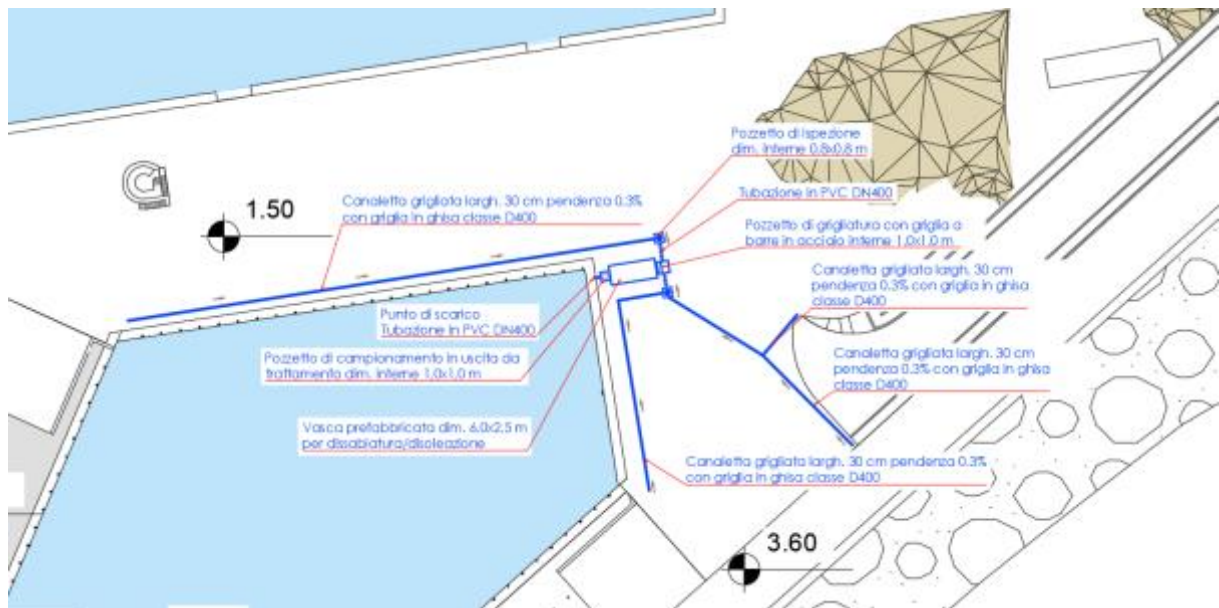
Planimetria di progetto riferita al sistema di trattamento e raccolta delle acque di prima pioggia
